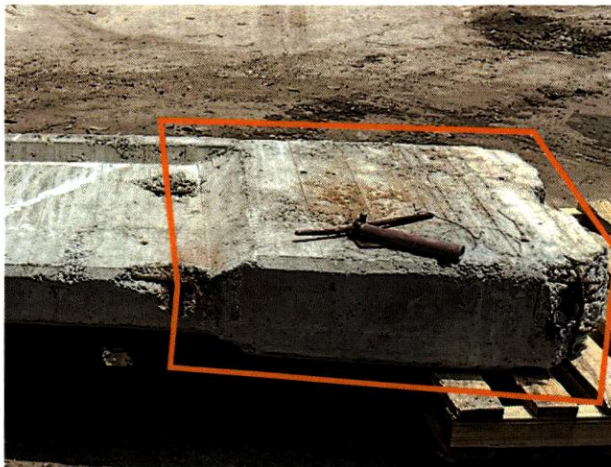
Extremo típico de viga identificado en el espécimen F-A-BM-8 (recuadro naranja).
